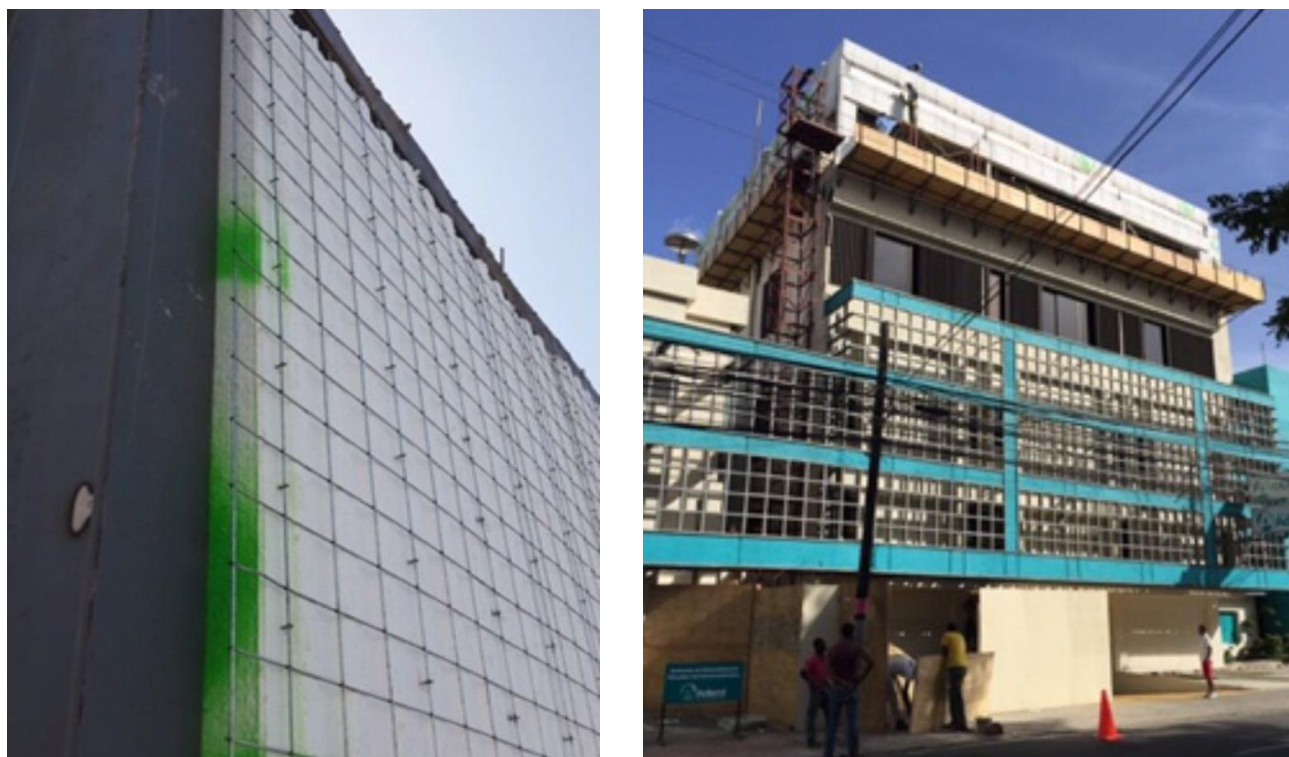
Paneles de Poliestireno muros de cerramientos estructura metálica Edificio Anexo y Madame Curie Banco Ademi. Fuente: Fotografía de Autor
